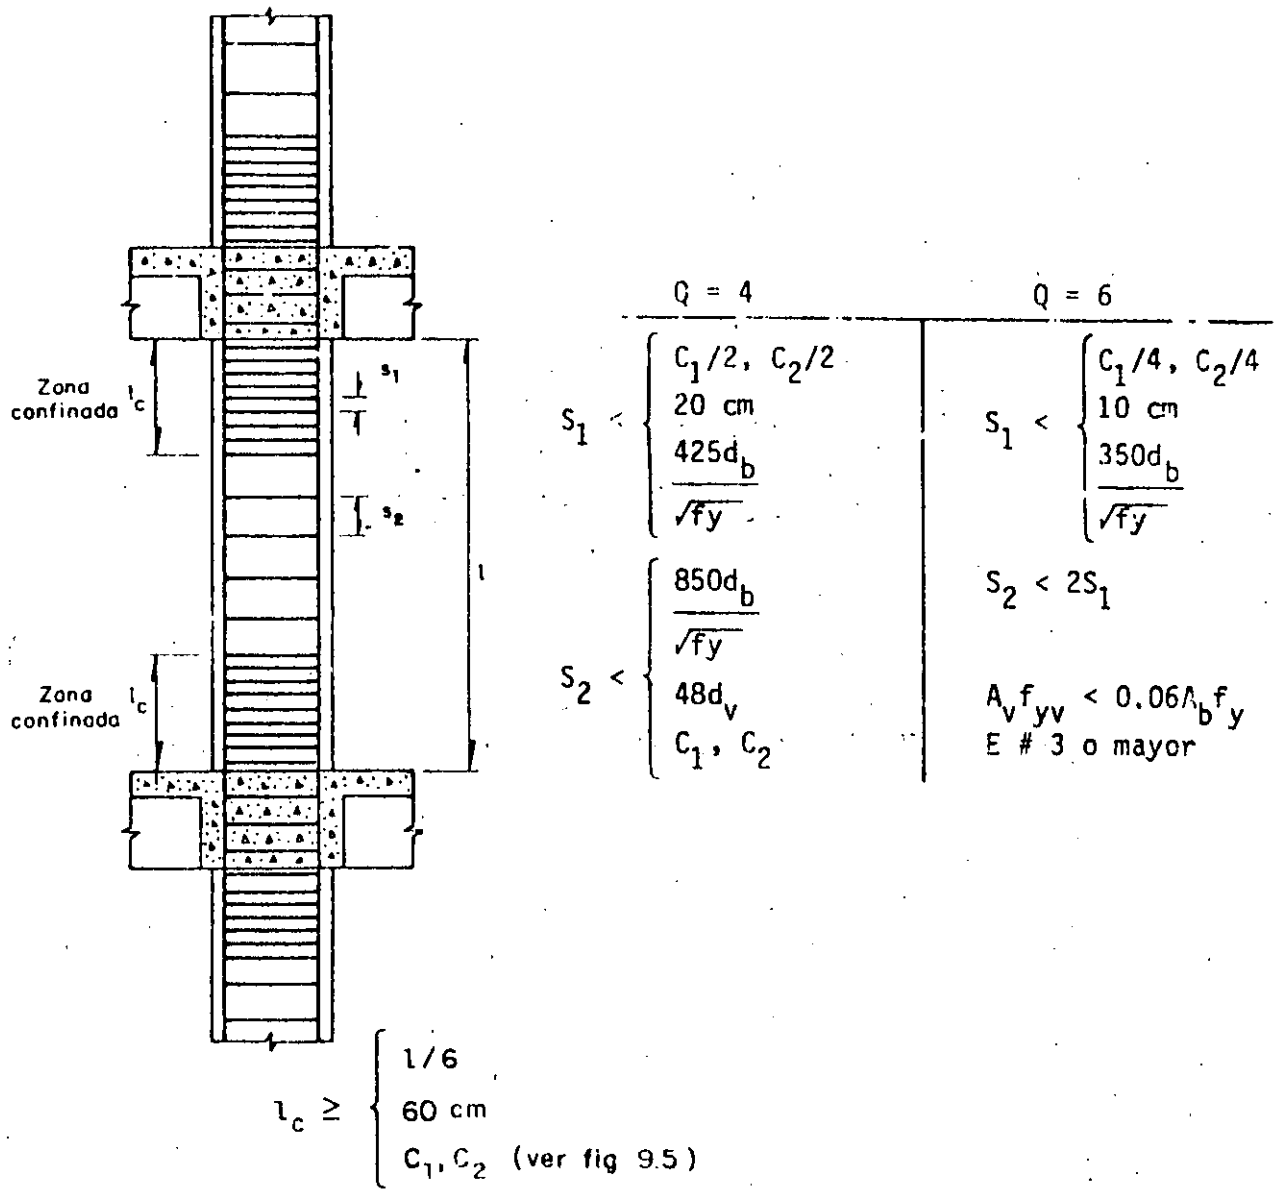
Requisitos para refuerzo transversal en columnas de concreto
